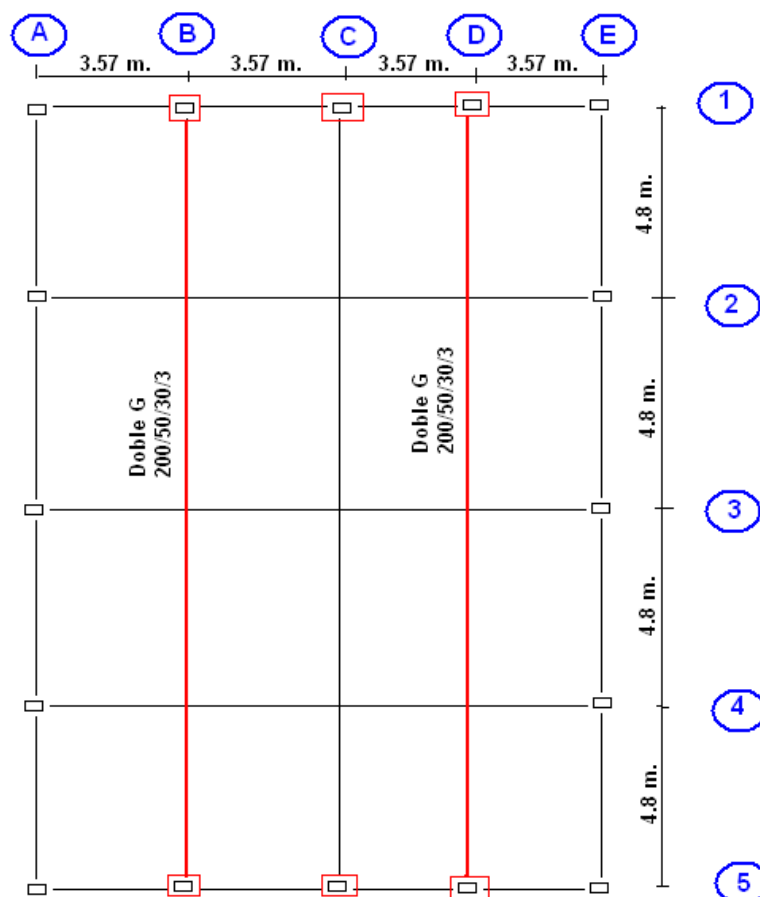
Vista en planta de la estructura reforzada de la Piscina del Colegio Sucre.
